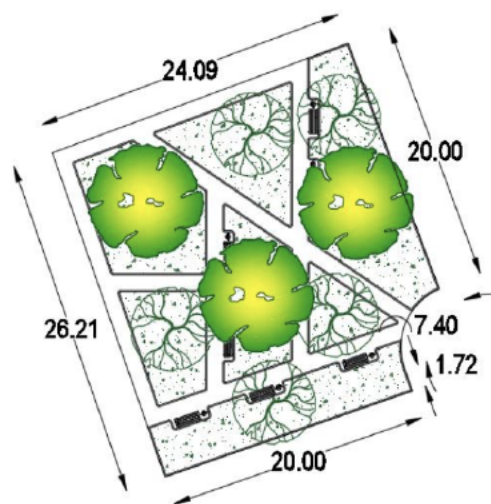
PLANTA DEL PARQUE "LA LECTURA".
